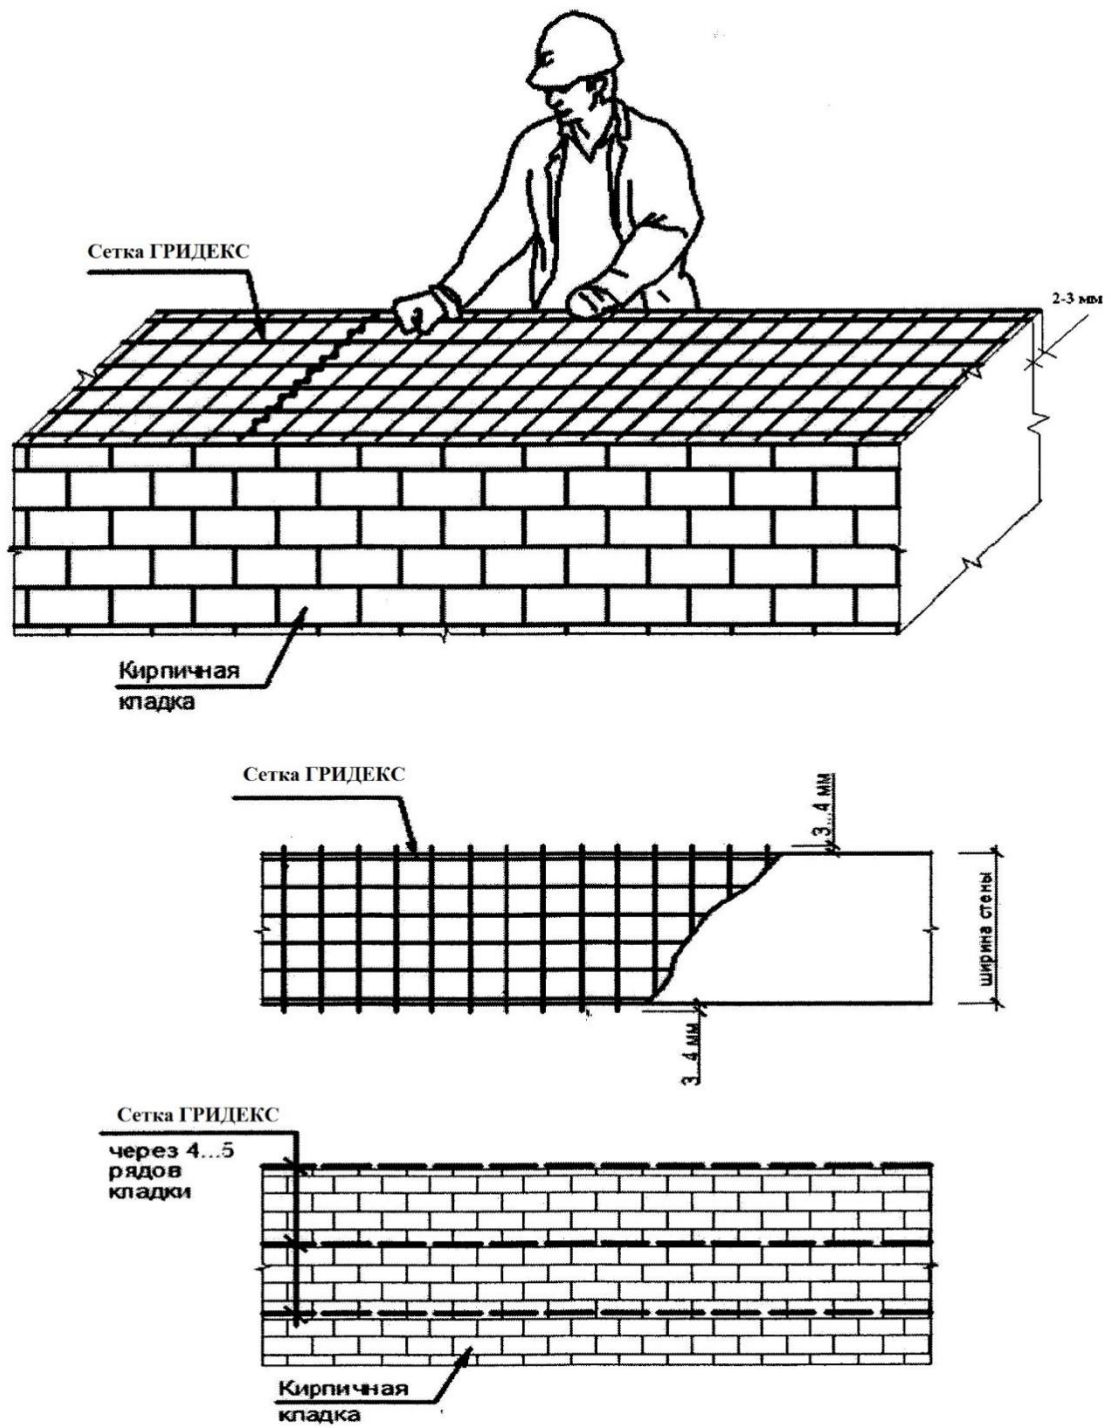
Схема армирования кладки сеткой ГРИДЕКС
